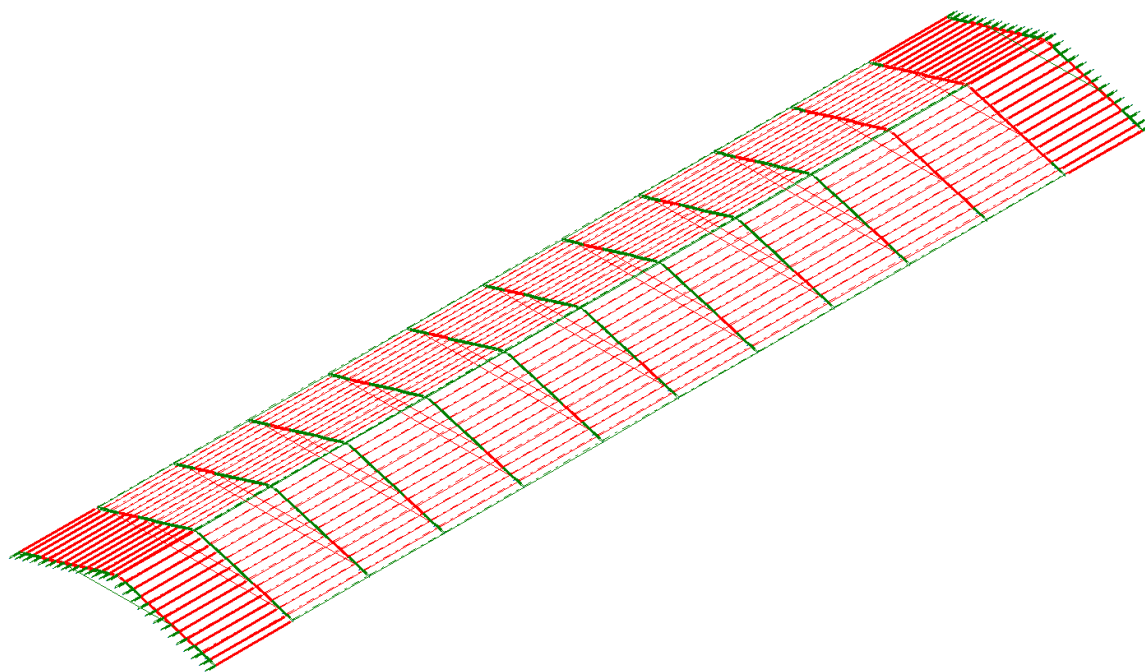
Análise estrutural do modelo executado no Bloco 02.
